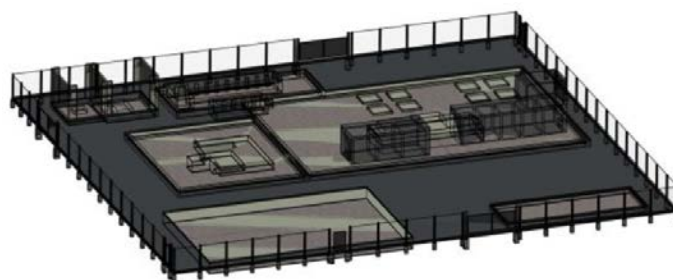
Vista 3D modelo arquitectónico, software Revit.
